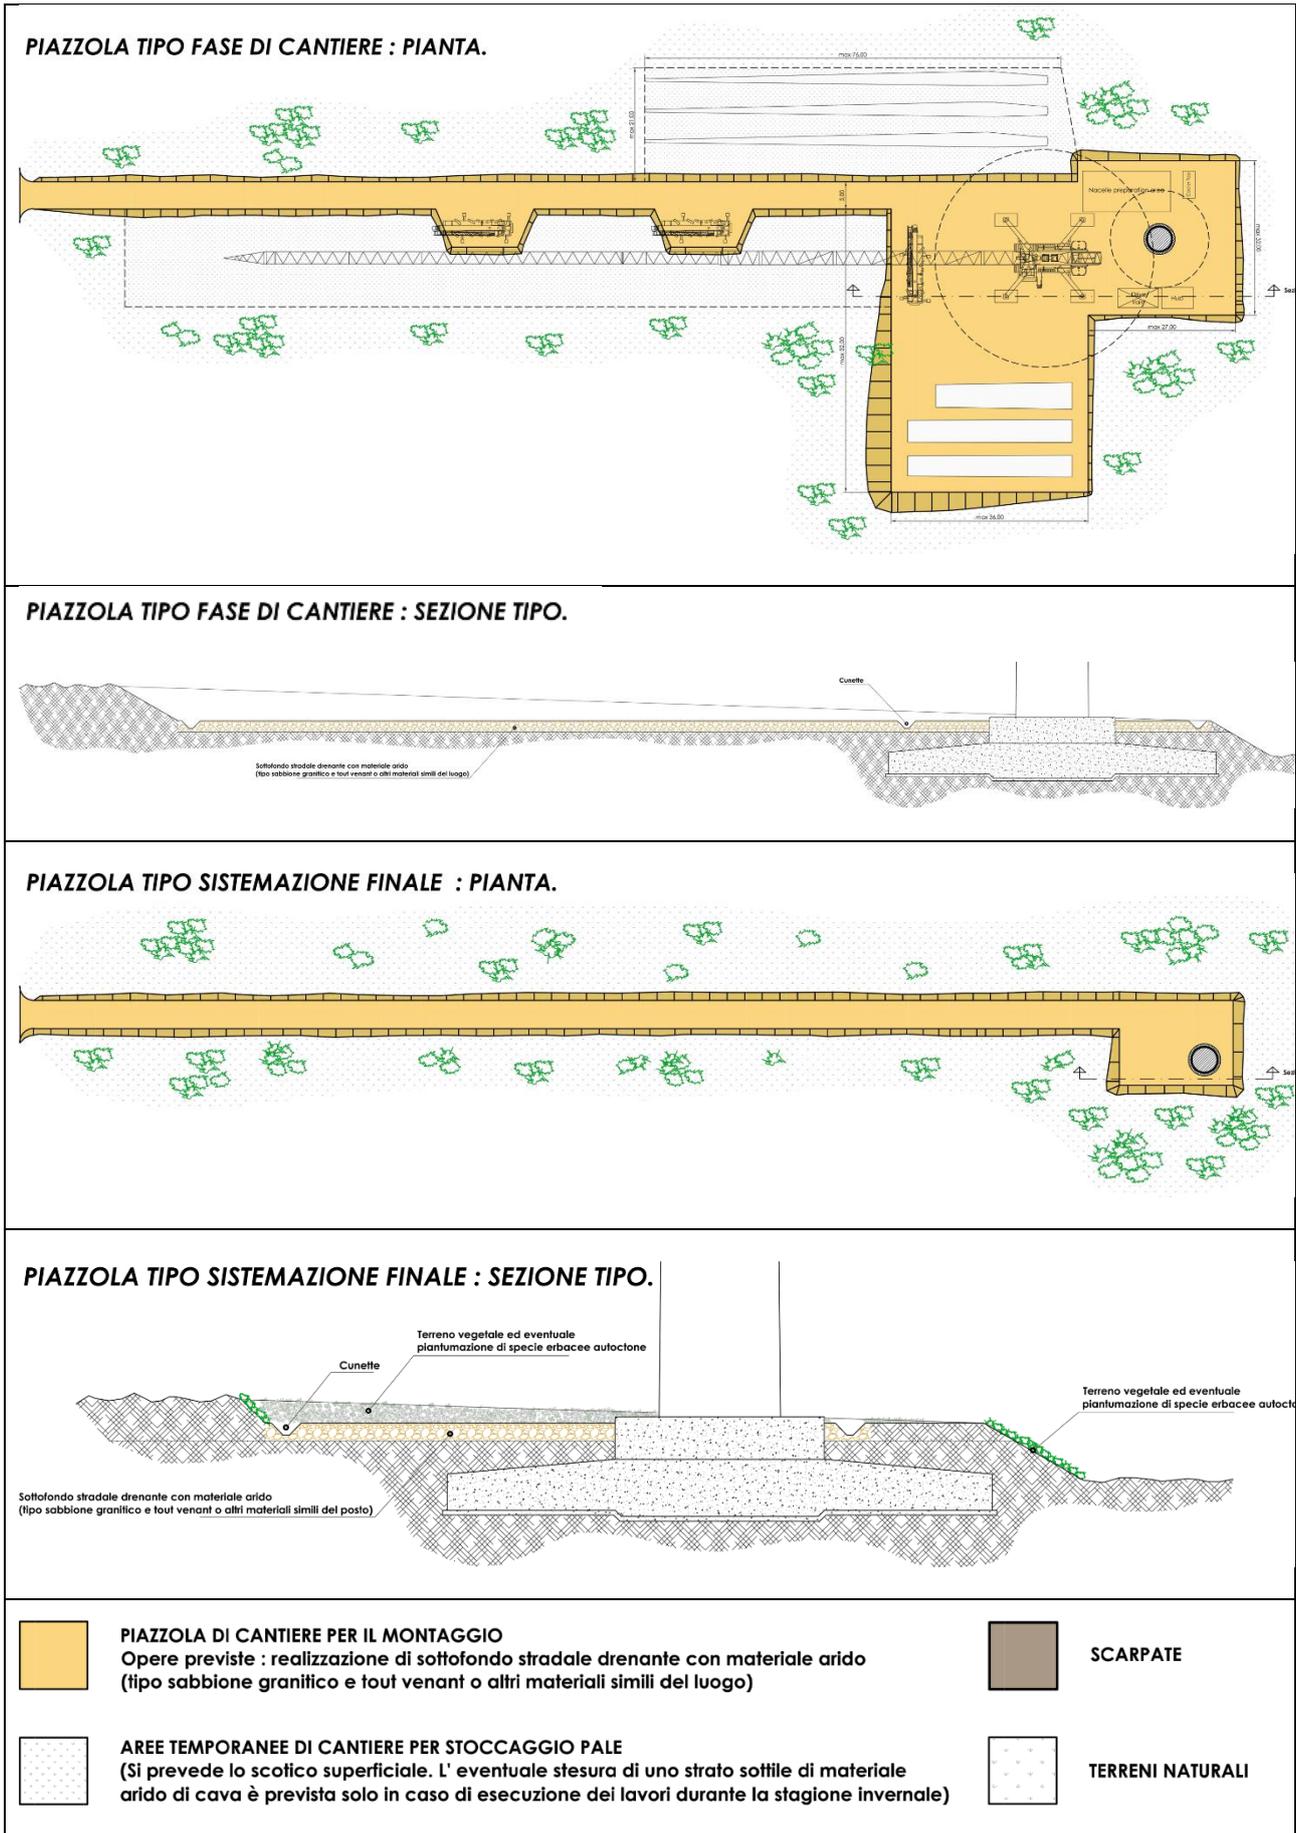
Schema progettuale delle piazzole di progetto (Piante e sezioni sia in fase di cantiere che di esercizio)
